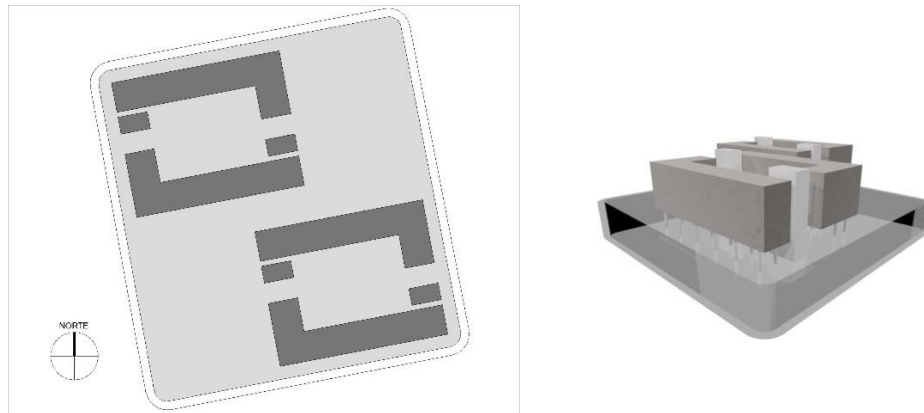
Implantación en claustro doble ortogonal a norte. Planta - isométrico. Fuente: Elaboración propia.
